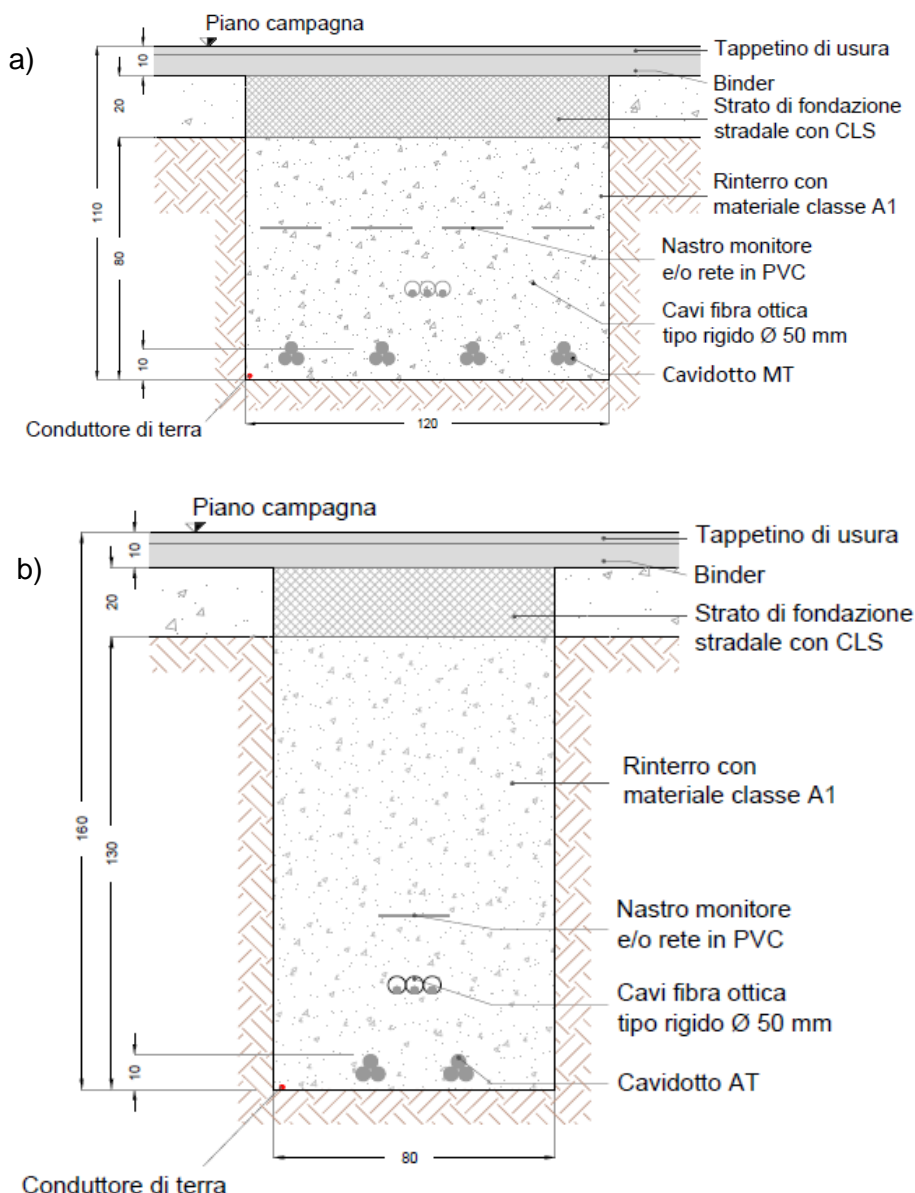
Sezione tipo cavidotto su strada asfaltata: (a) Cavidotto 30 kV; (b) Cavidotto 150 kV
